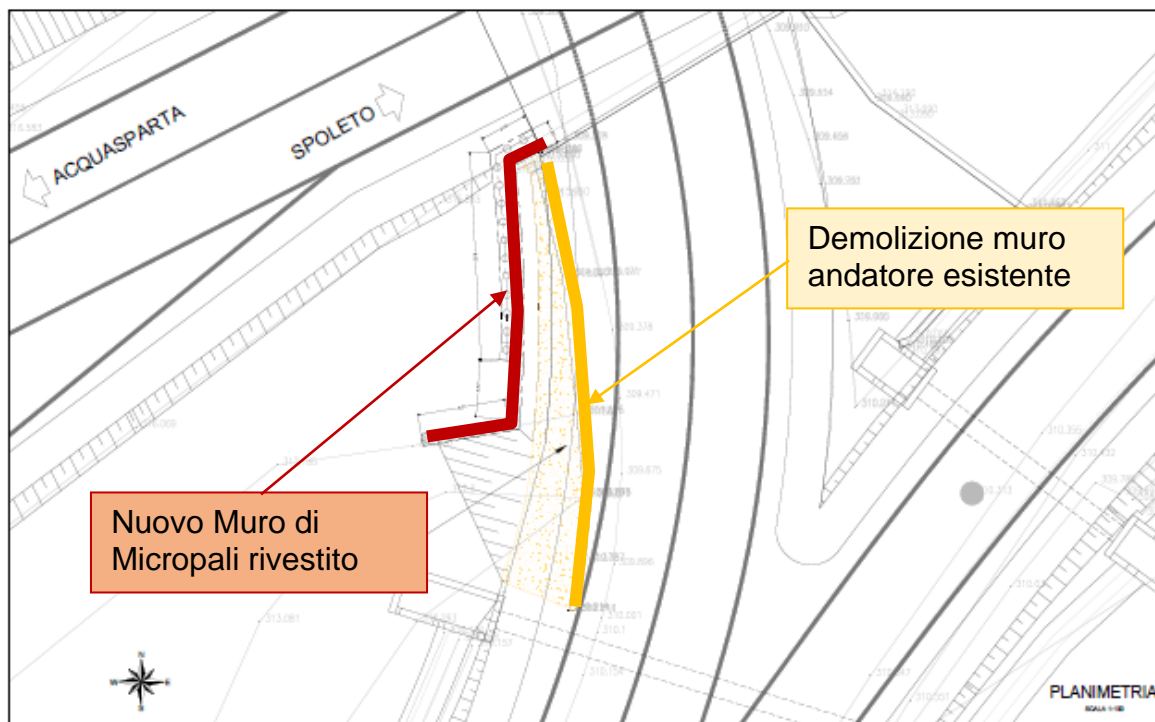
Stralcio Planimetrico dello Svincolo di Baiano con l'evidenza della porzione del muro da demolire e del nuovo da costruire.
